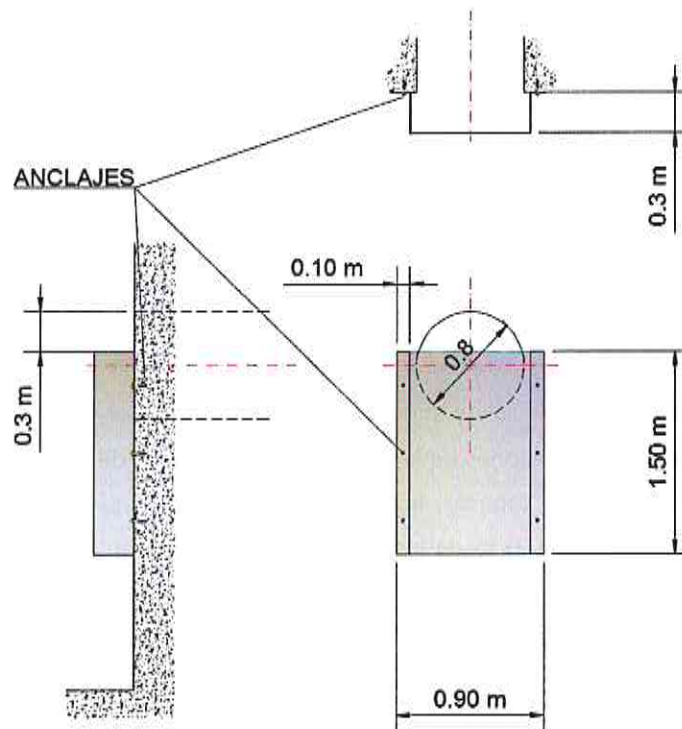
Geometría del montaje de la chapa deflectora. Fuente: Elaboración propia
